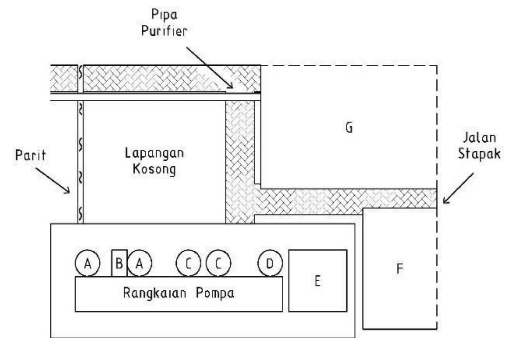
Denah penyimpanan kimia 1 Keterangan:
